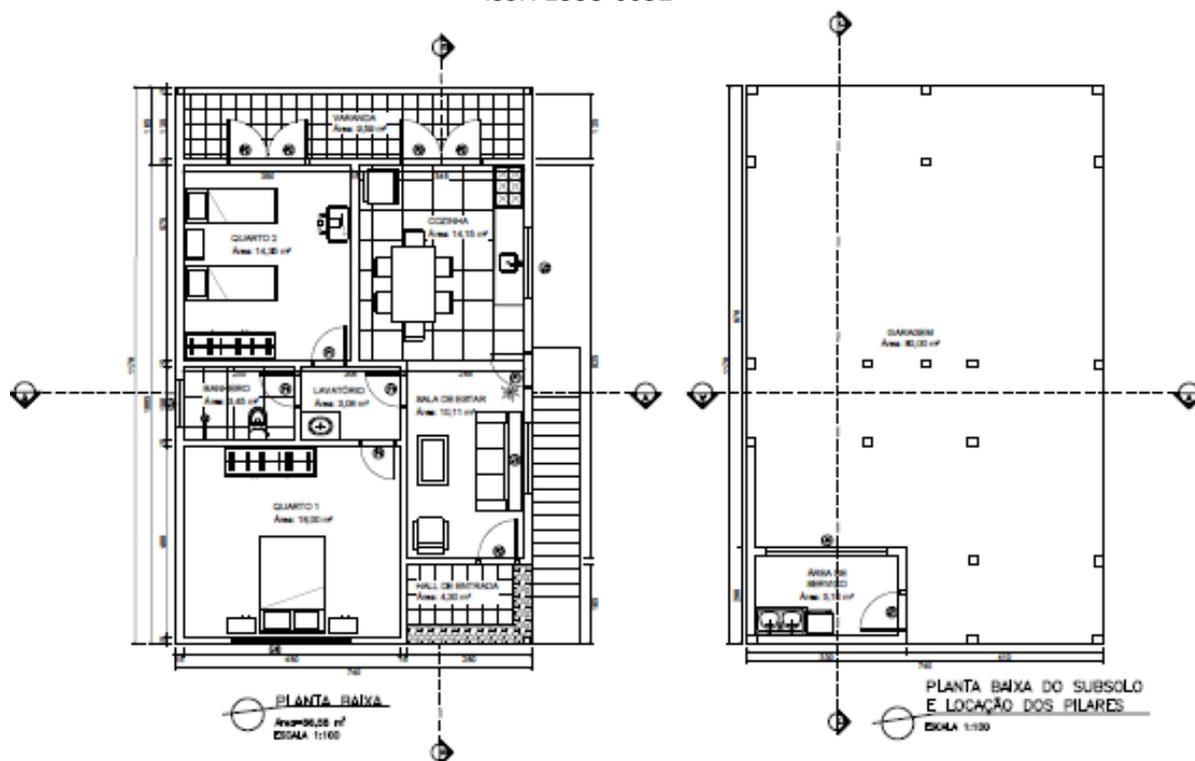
Planta baixa do térreo e planta baixa do subsolo.
